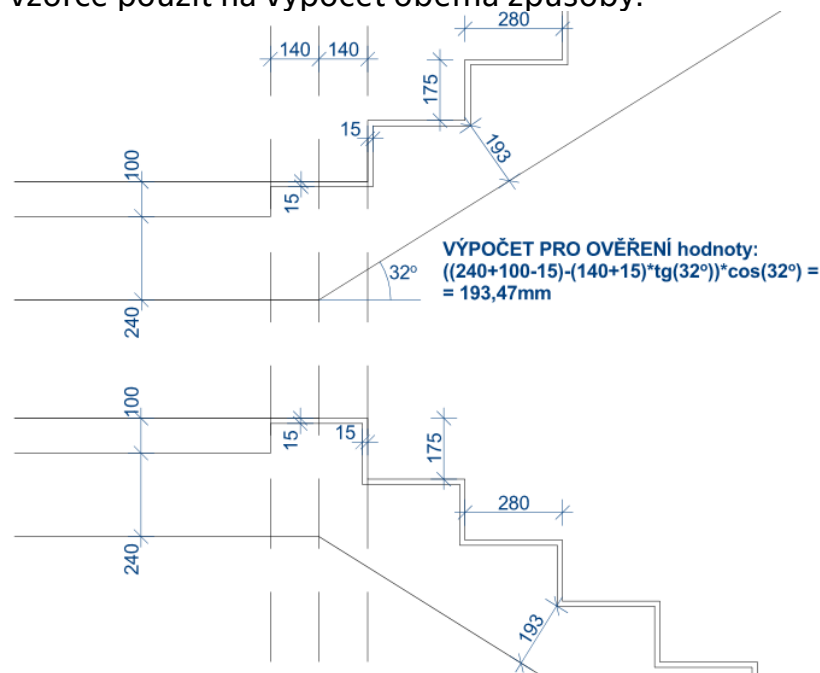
Konstrukce detailu 2 – hrany nástupního a výstupního stupně posunutě o šířku stupně; z rozměru t (tloušťka ramene i se stupni a jejich úpravou) je odvozen celkový rozměr podesty, menší tloušťka podesty než v předchozím případě [13]
